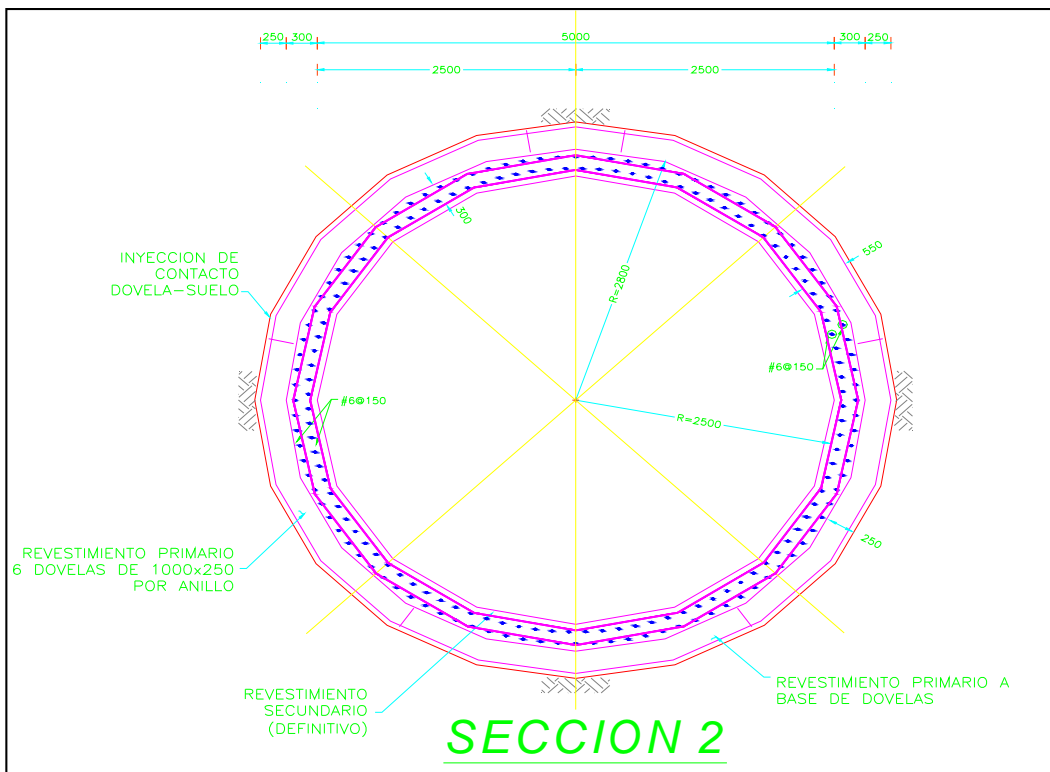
Armado de la sección 2 del revestimiento definitivo con acero No.8
